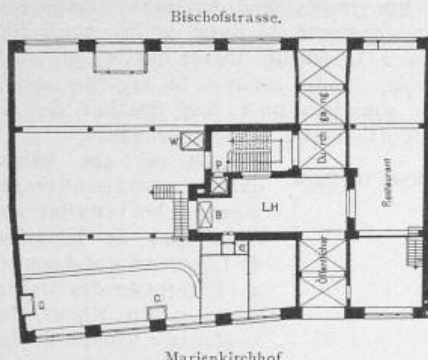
Erdgeschoss-Grundriss 1:500.
